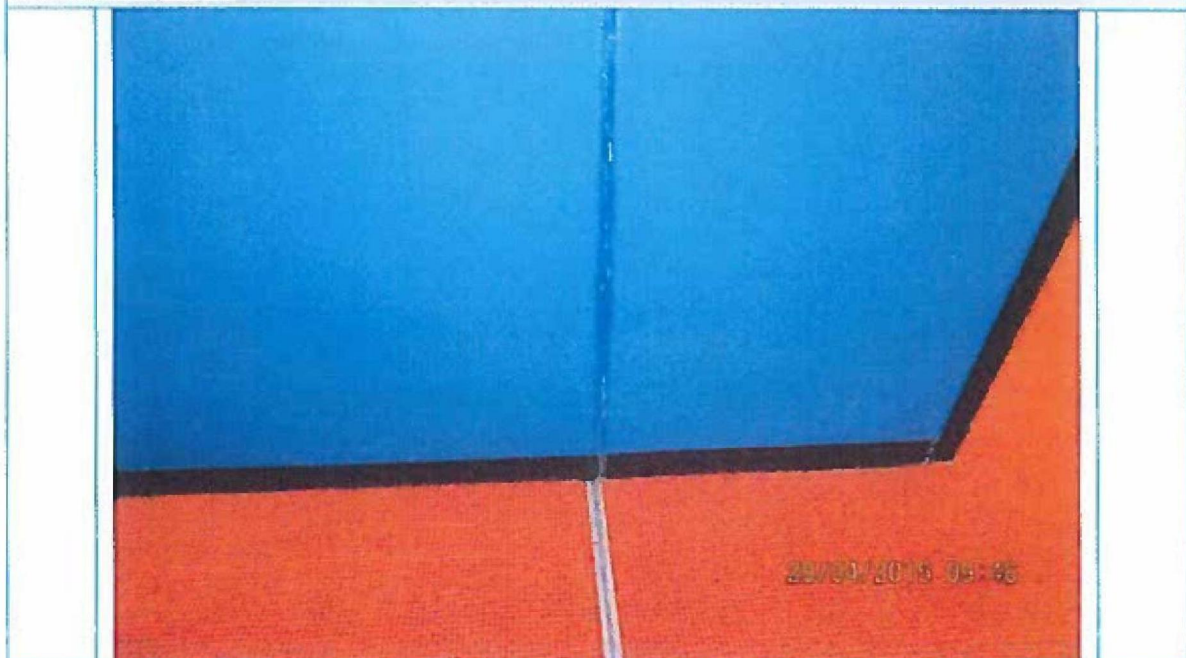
Kiervorming in kitwerk aanhechting plafond/oplegging. (kantoor 2.05) Geen gerelateerde bevestigsschade. Aansluiting bouwelementen.
